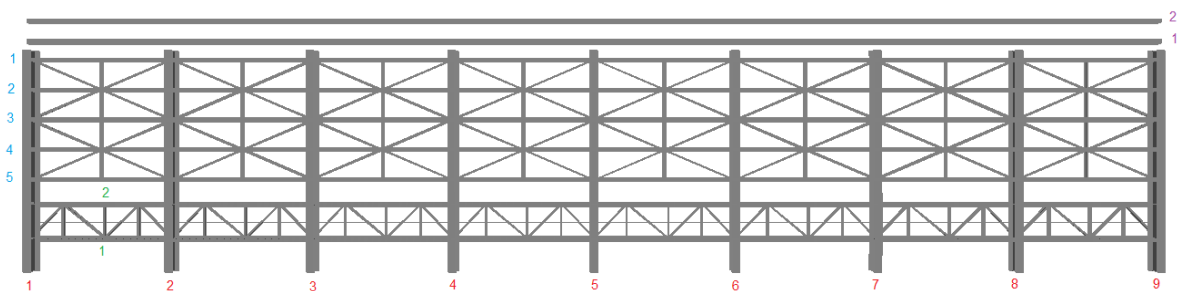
Vista en planta de los largueros del tramo metálico levadizo, se observa numeración de los largueros.
